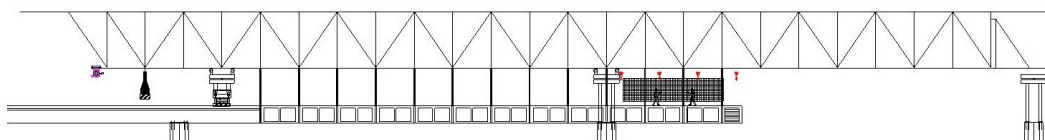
Dia 1 - Cura do betão e pré-fabricação da armadura [7].
